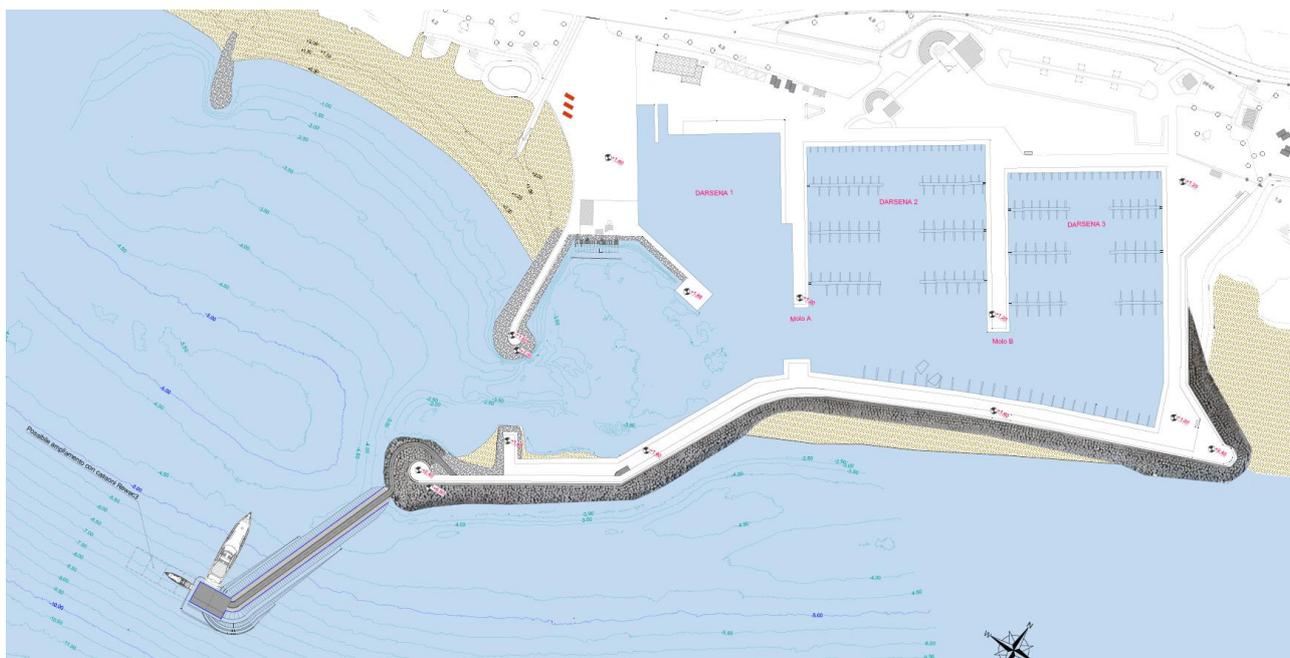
Stralcio planimetria di progetto (cfr. Elab. A.07)
